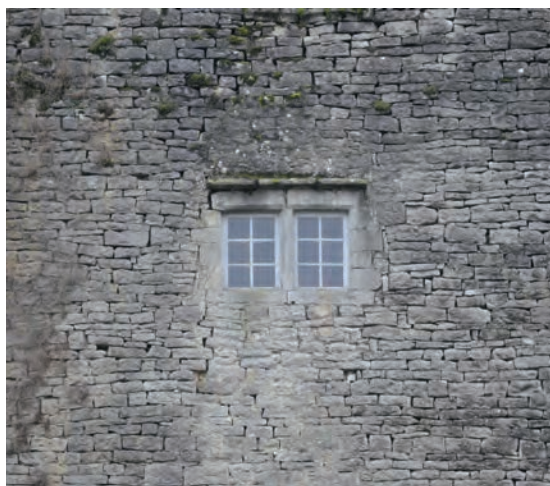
Parement extérieur de la baie (UM2-3-UC1)
